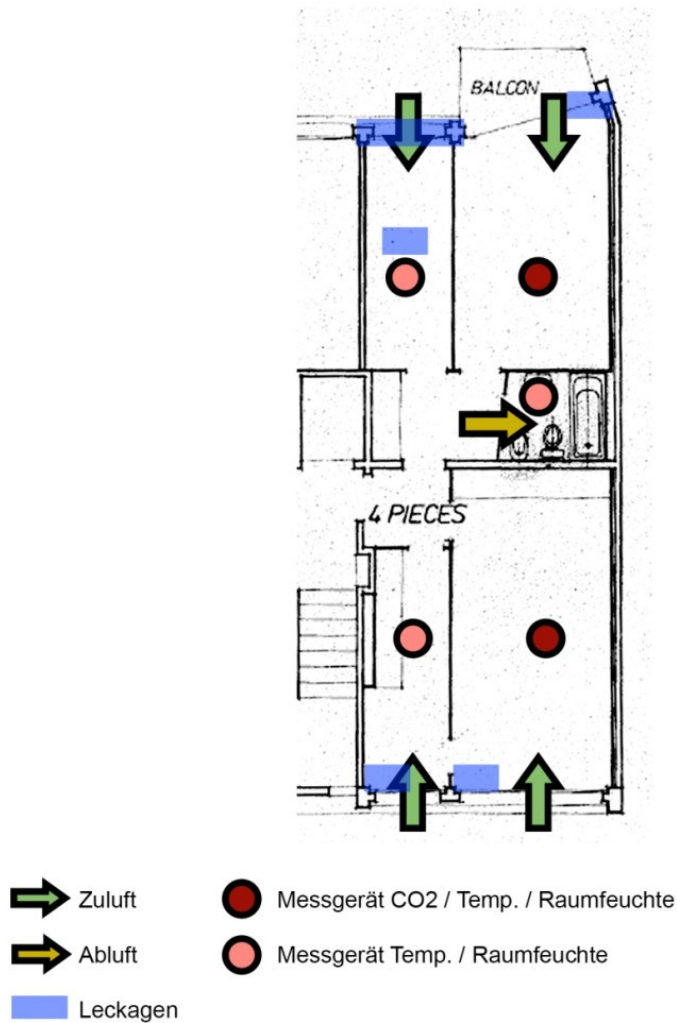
MFH Genf: Grundriss Wohnung E
